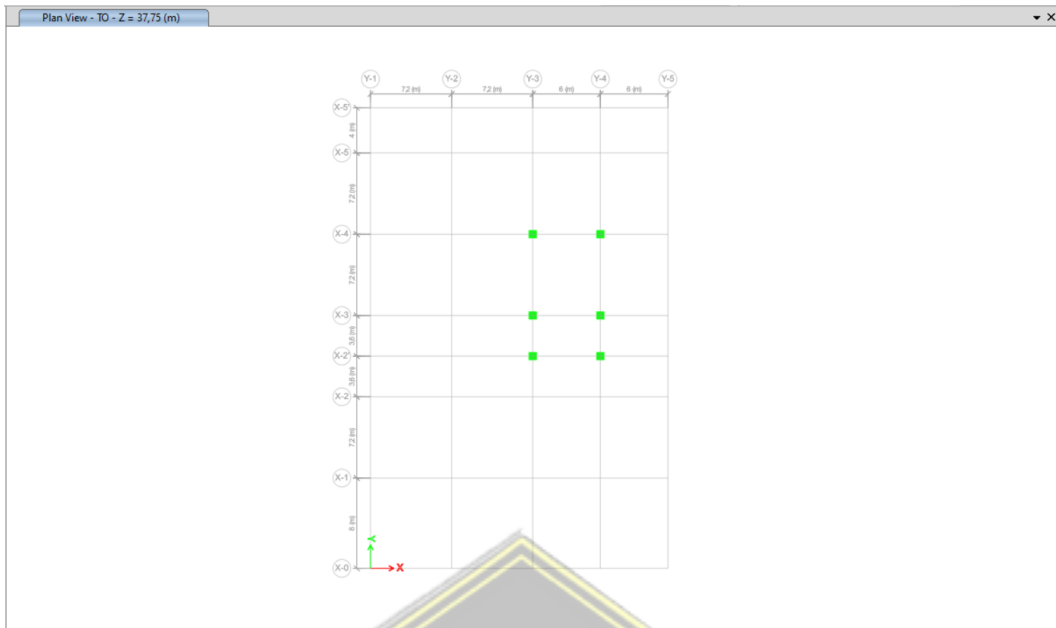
Denah Kolom Lantai 4 dan Lantai 5
